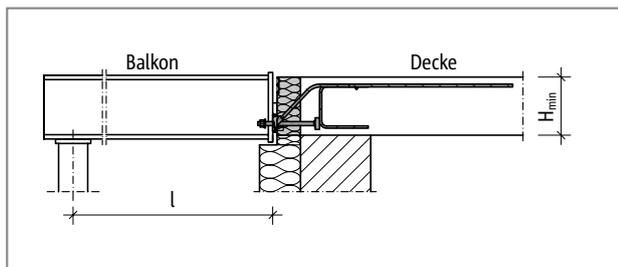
Schöck Isokorb® T Typ SQ: Statisches System
